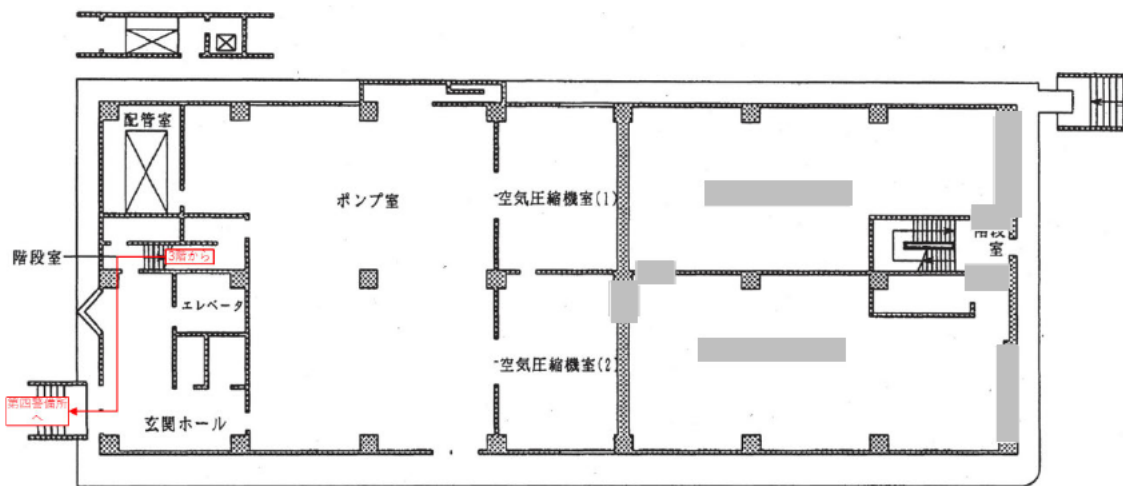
(2) 移動経路 (ユーティリティ施設 地上1F 平面図)
